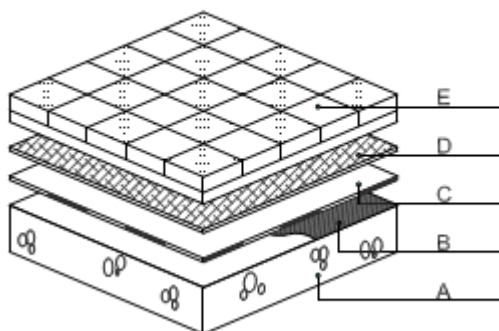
Envoltente exterior do Bloco D (pavimento).
